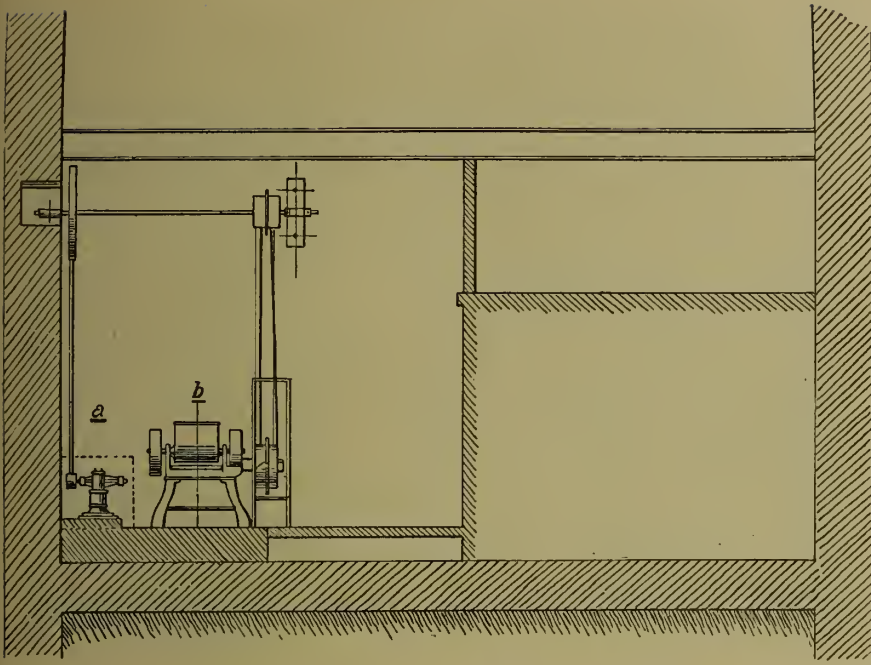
Aufriß einer Bäckerei mit Maschinenbetrieb.
